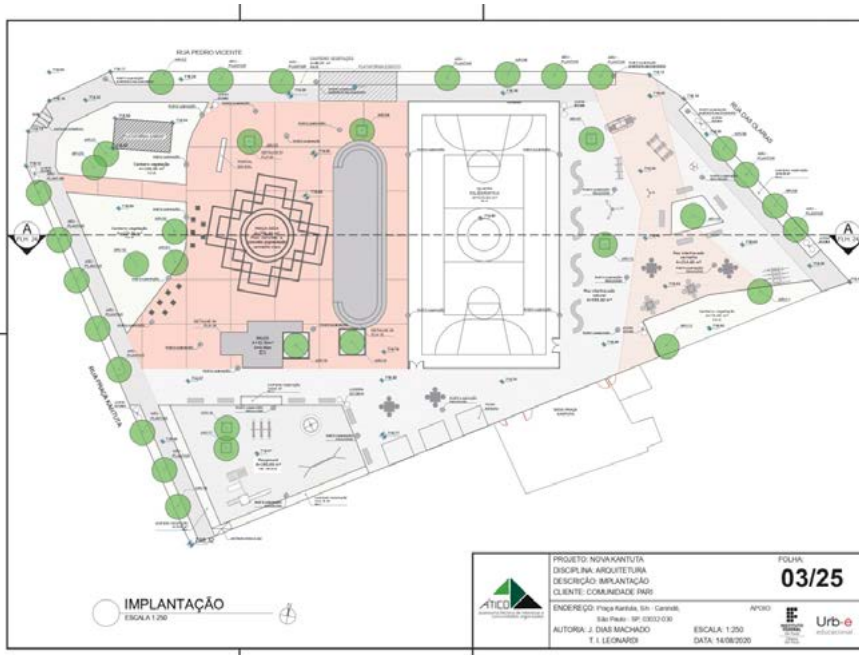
Planta de implantação da praça Kantuta. Fonte: Autorial, 2020.
